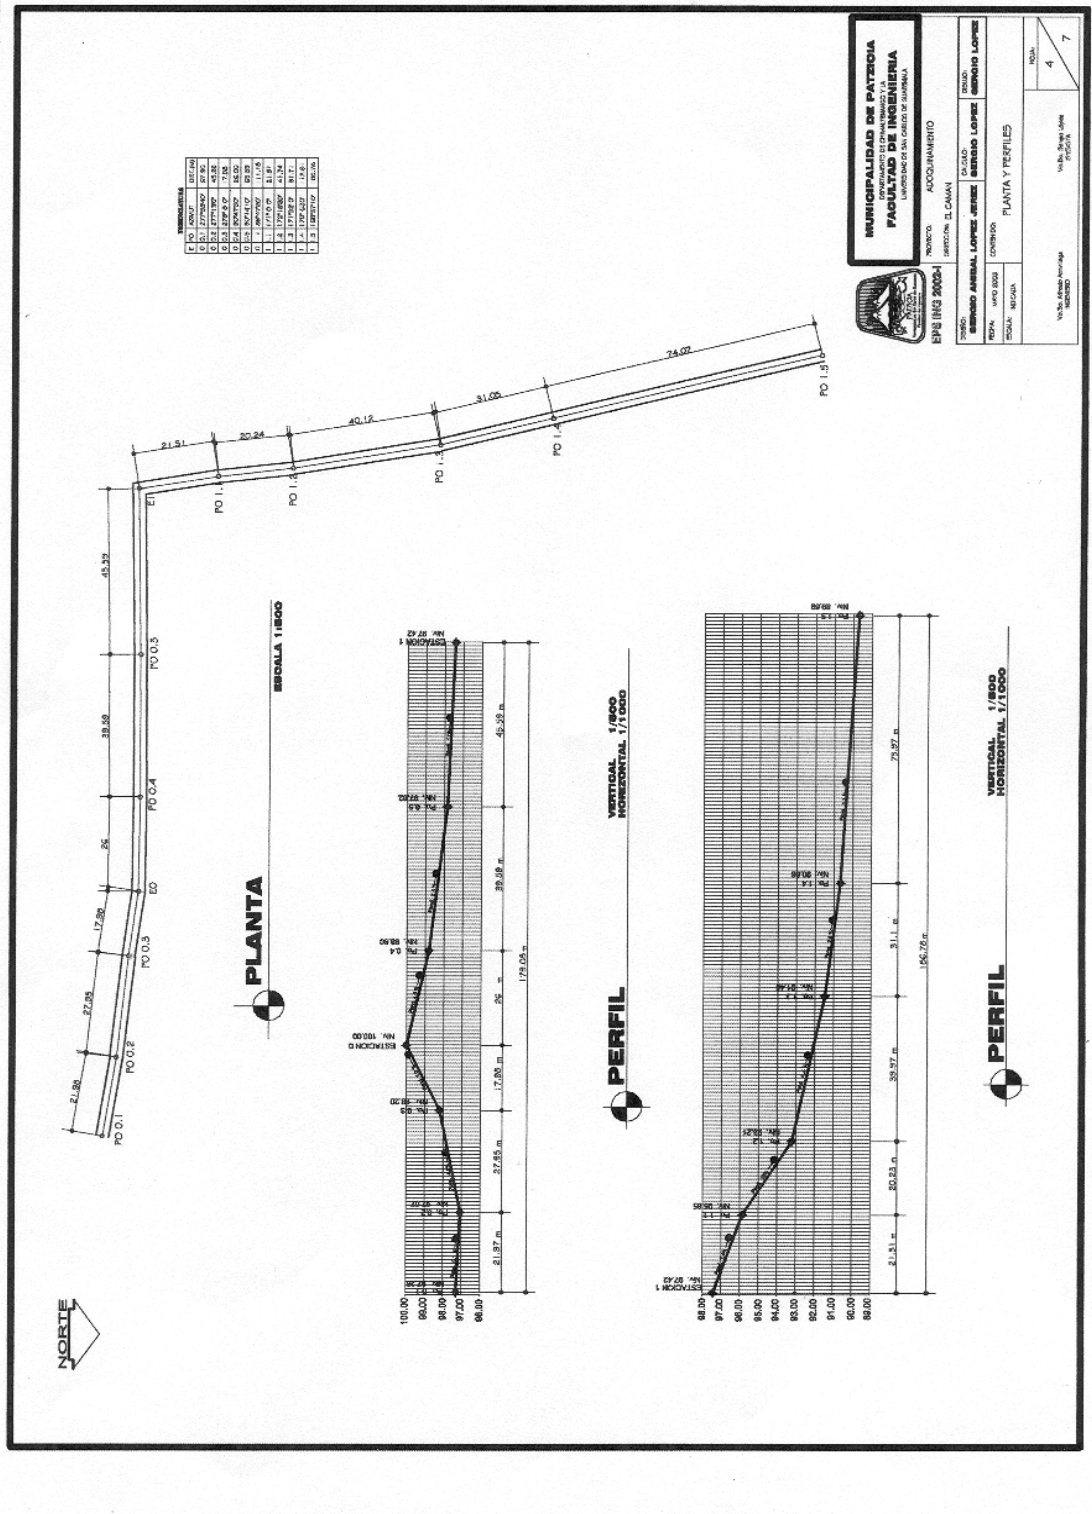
Plano de la planta/perfil de la calle Los Chinos
